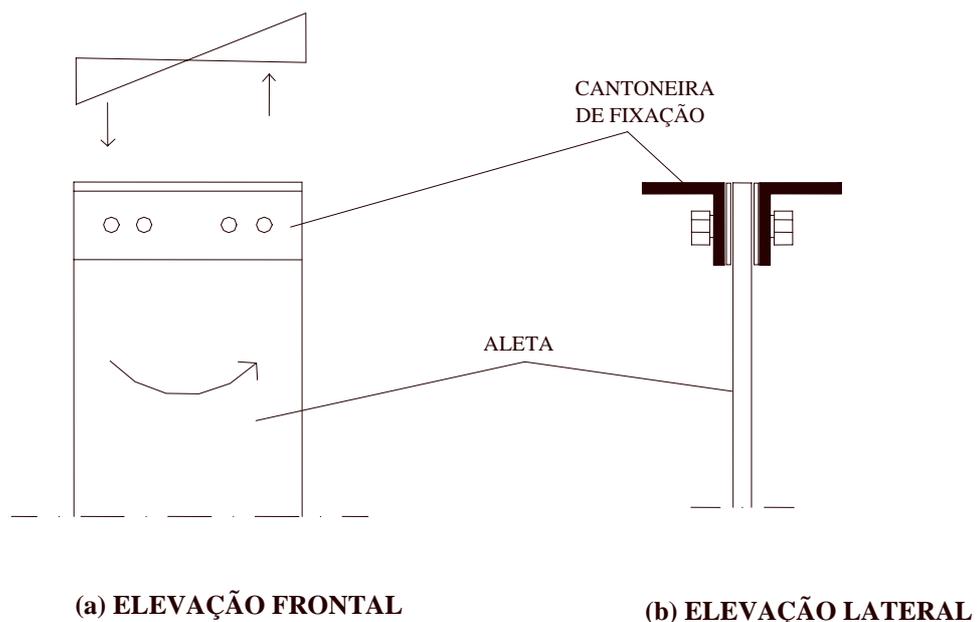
Fixação das aletas com cantoneiras: (a) Elev. Frontal – (b) Elev. Lateral.
